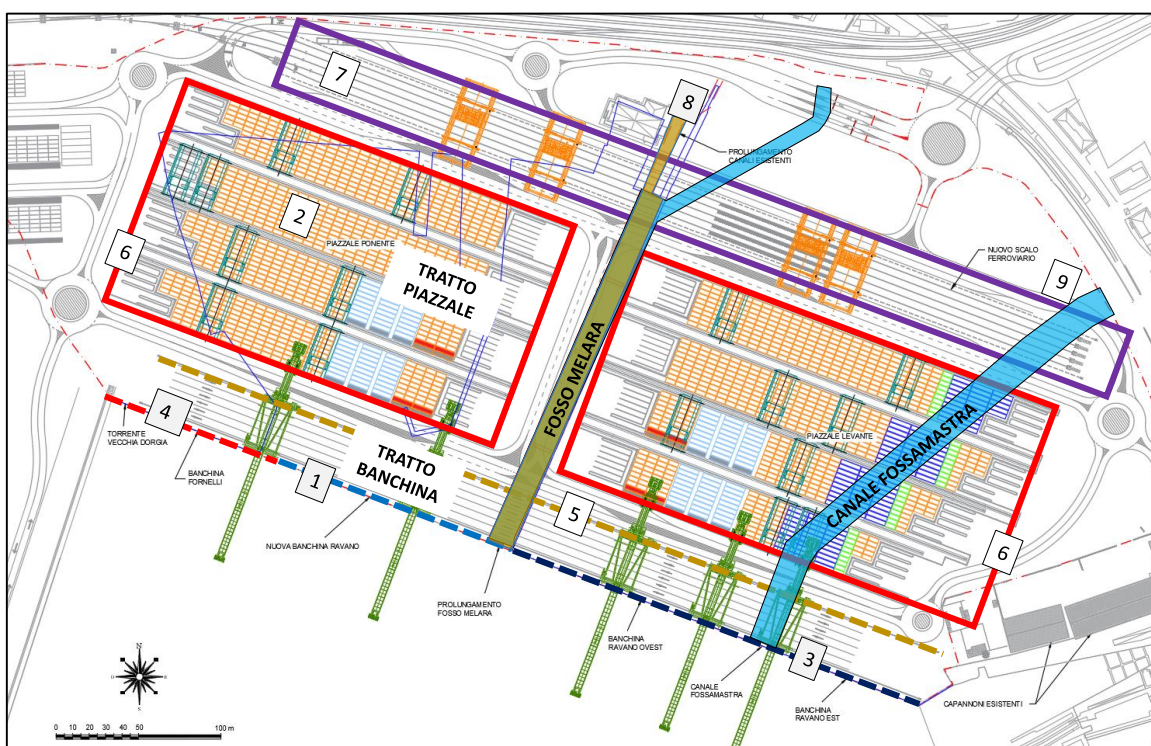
Individuazione in pianta delle due tratte per il progetto della Canalizzazione Melara
